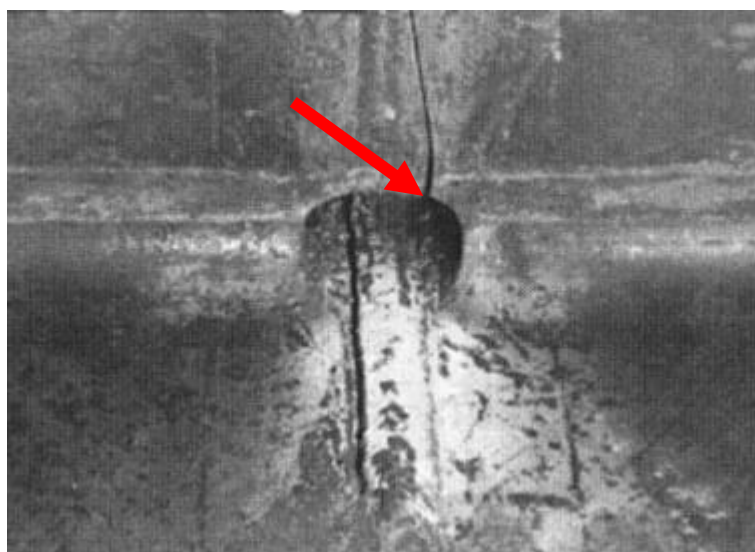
Fissura em um *cope hole* na emenda de uma viga de ponte, Kuehn et al. (2008).
